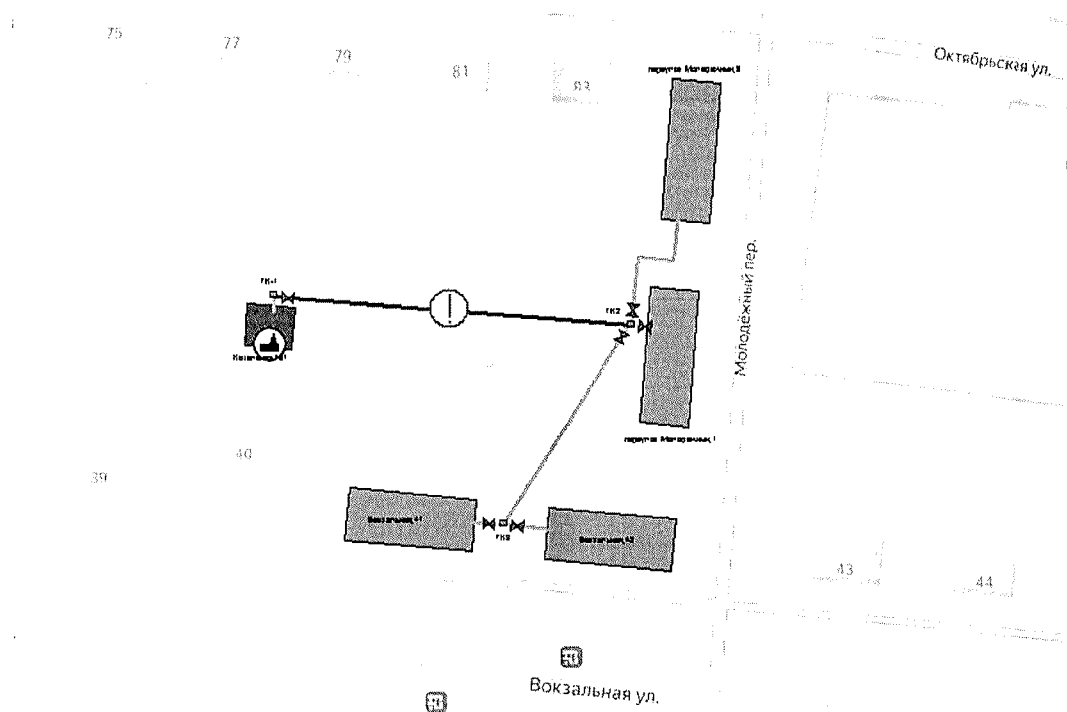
Трубопроводы, перекрытые для проведения ремонтных работ.
